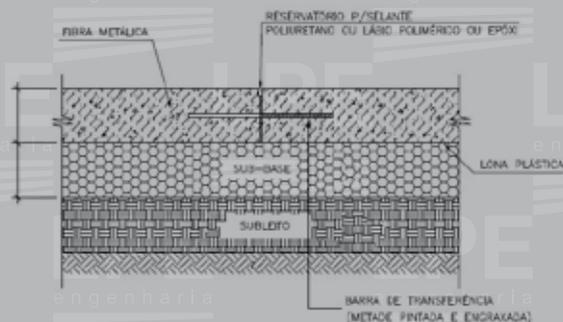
Seção típica para piso com fibras de aço (metálicas)
